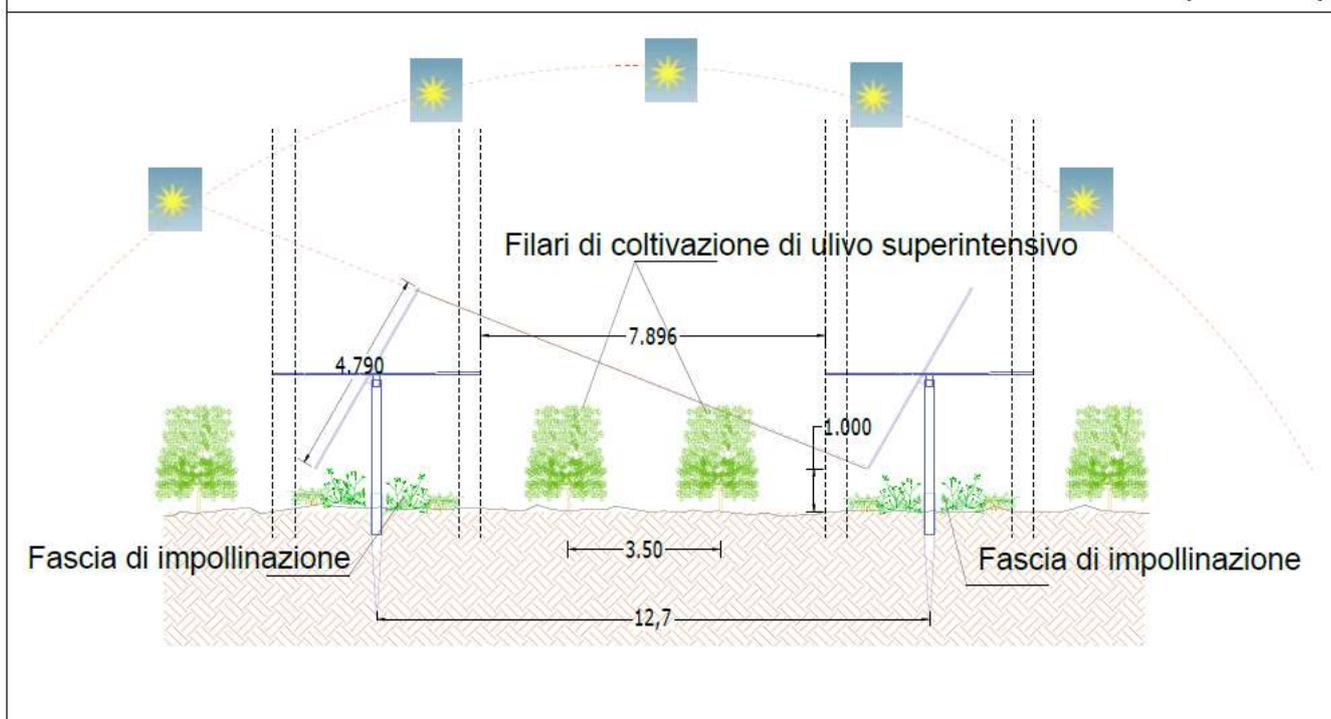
Particolare coltivazione oliveto interfila lotto 5A
